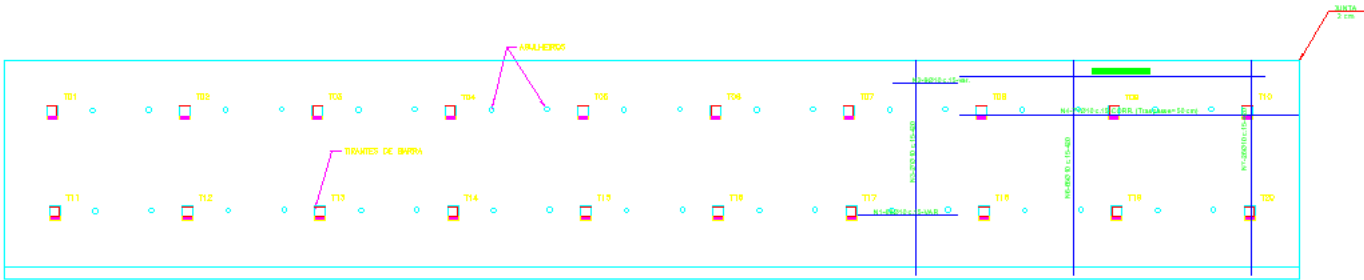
Detalhe de Armadura da Cortina Atirantada
